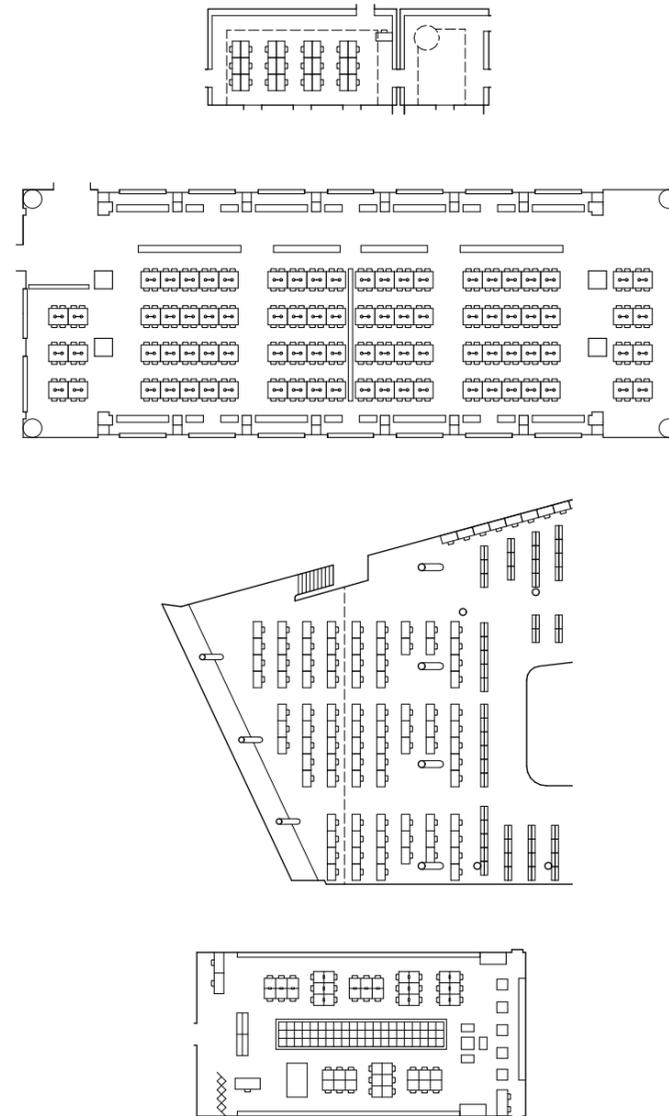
Grundrisse der Referenzräume, M 1:500
